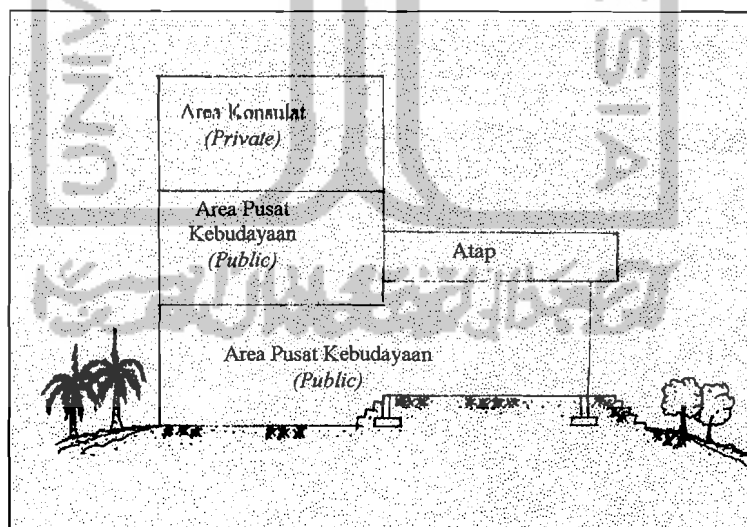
Bentuk Bangunan secara Horisontal.
